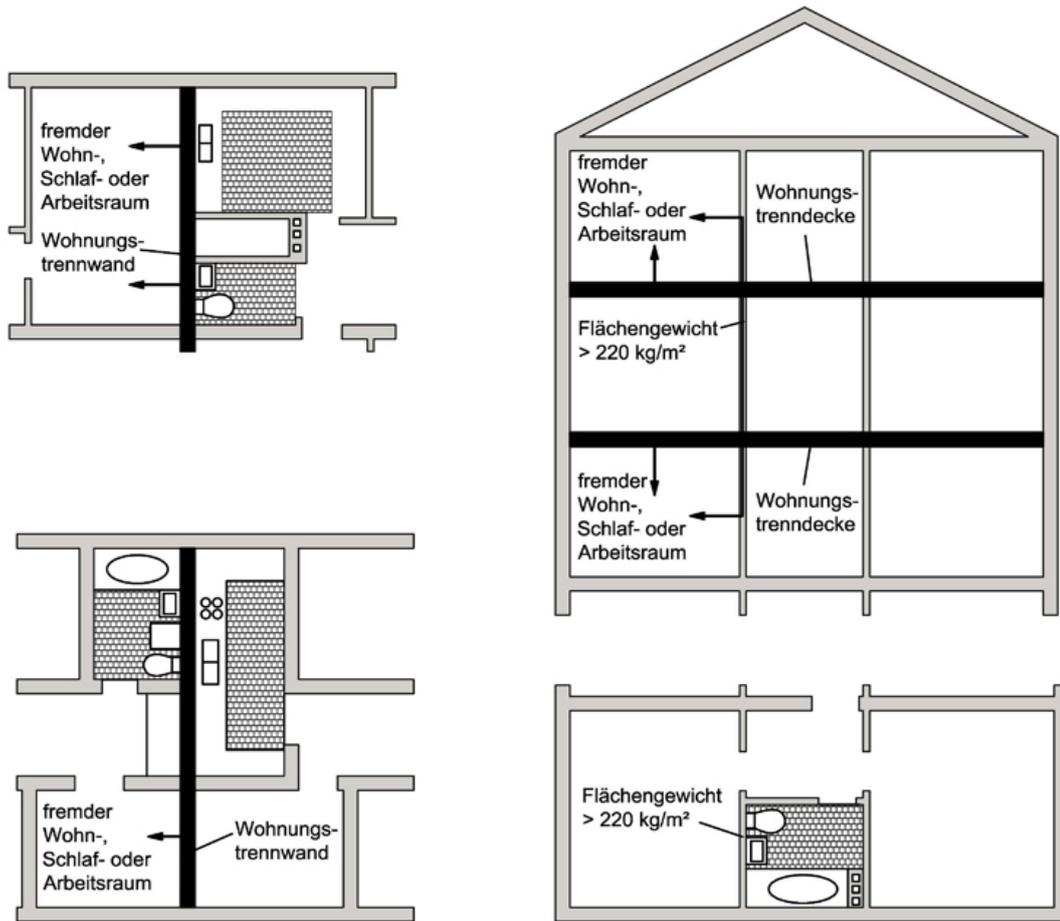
Beispiele für bauakustisch ungünstige Grundrisslösungen
